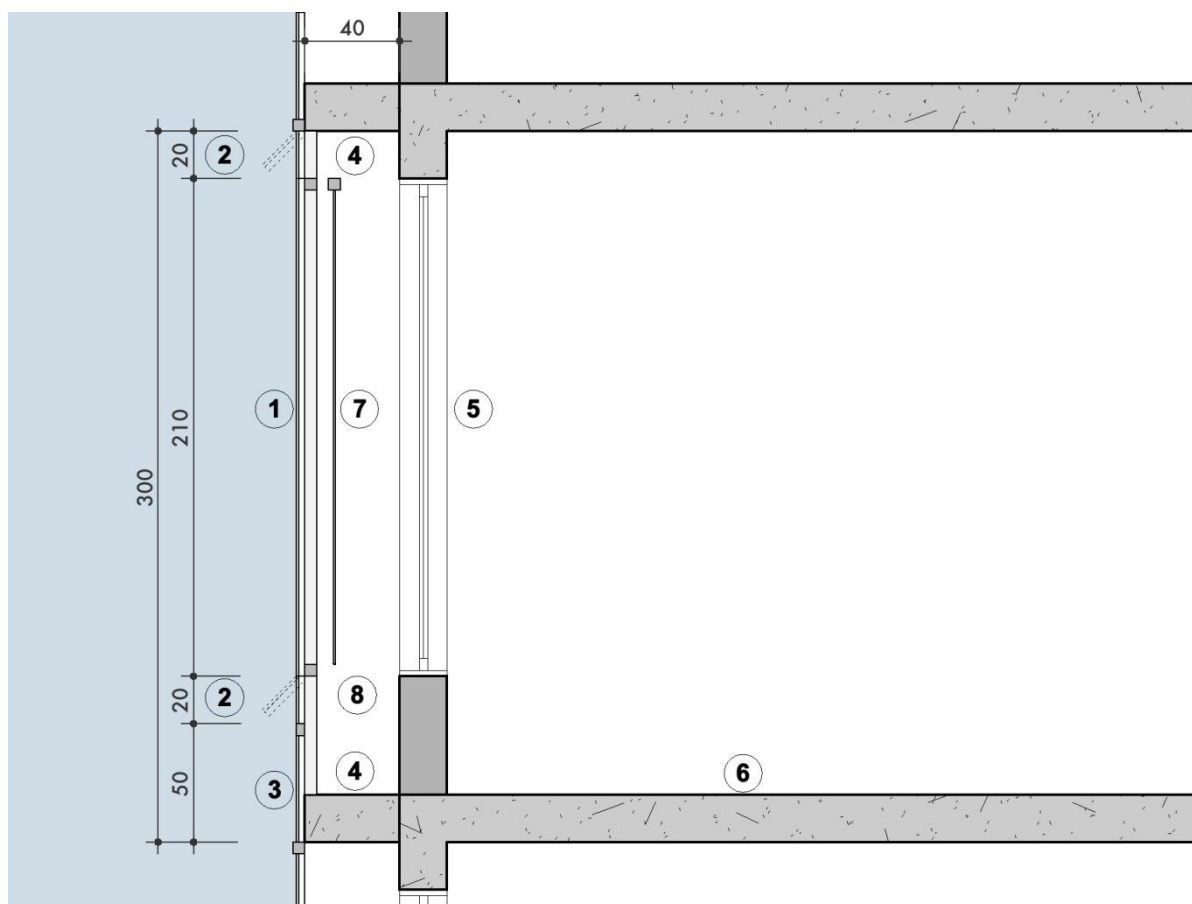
Módulo da fachada dupla ventilada proposta – corte parcial.
